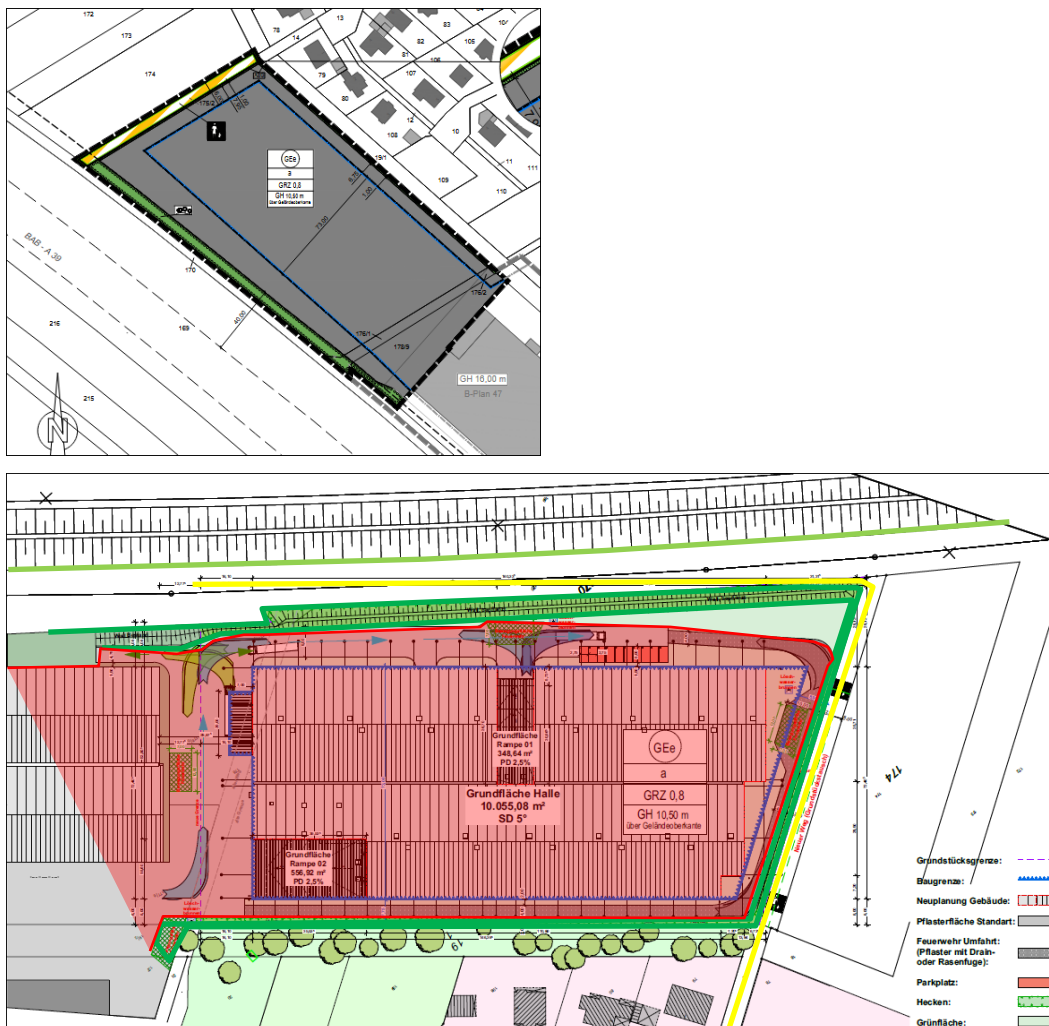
B-Plan oben und Planung mit Flächeninanspruchnahme (rot) und Grünstrukturen
